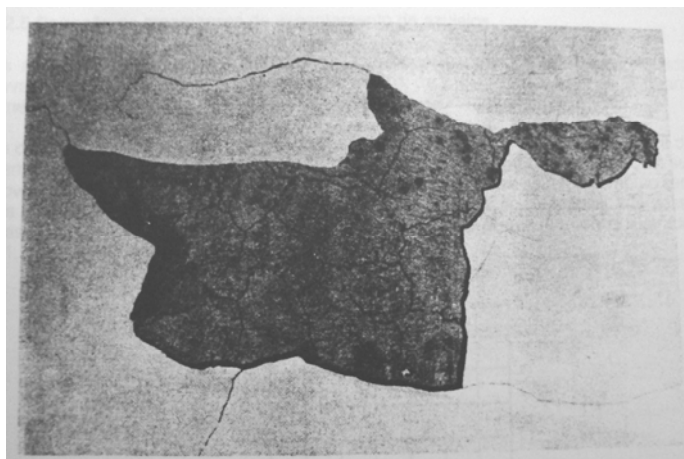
Fissuras de retração no revestimento em argamassa, podendo-se observar que o distanciamento entre as fissuras presentes no emboço (mais rígido) é menor do que aquele verificado no reboco (mais elástico)
